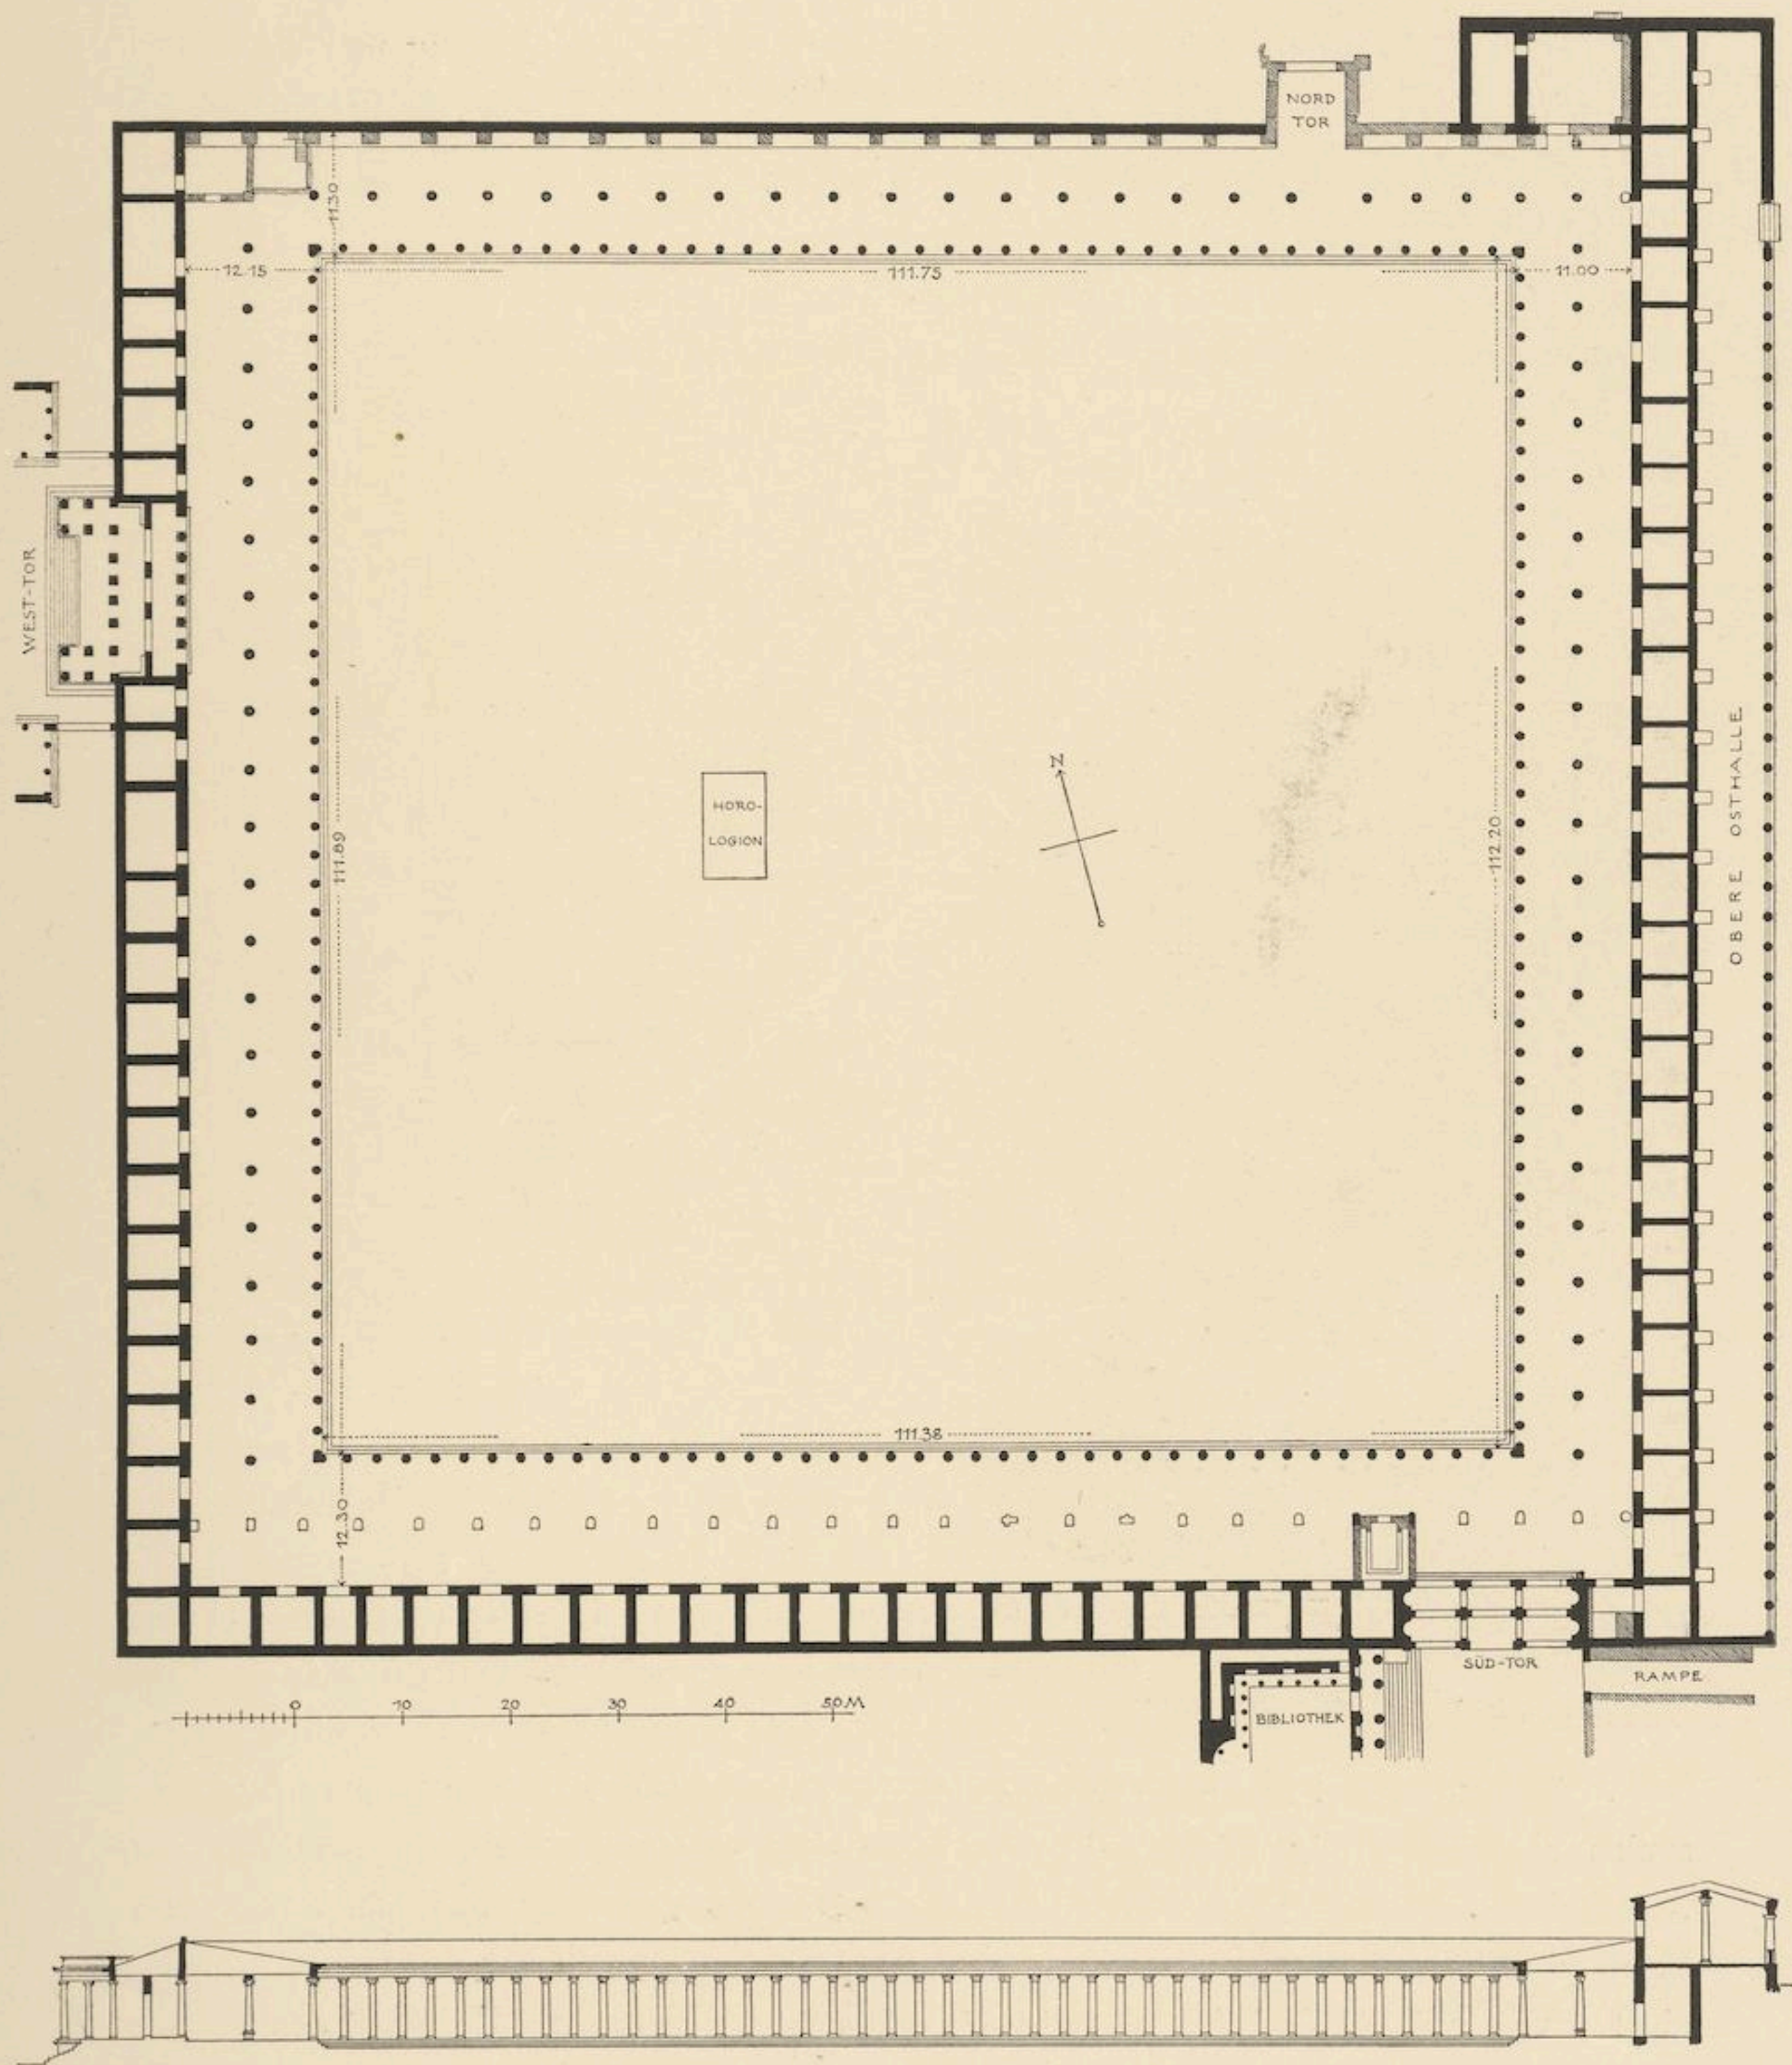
Rekonstruierter Grundriß und Durchschnitt.
